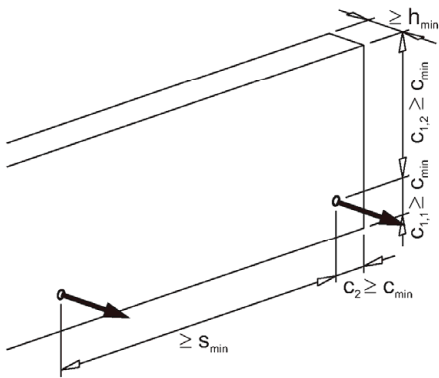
Einbausituation Wandfläche - Zugbeanspruchung, ohne Rückhängbewehrung
